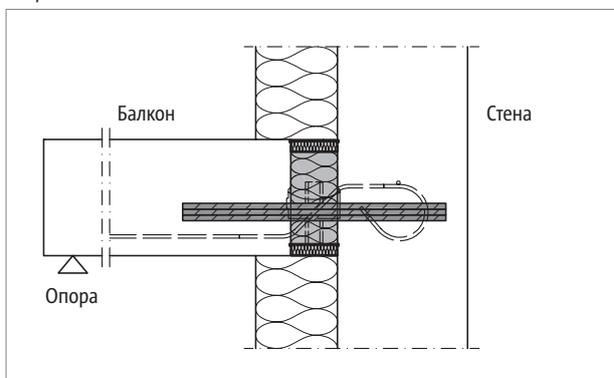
Schöck Isokorb® T mun HP: Конзолен балкон
